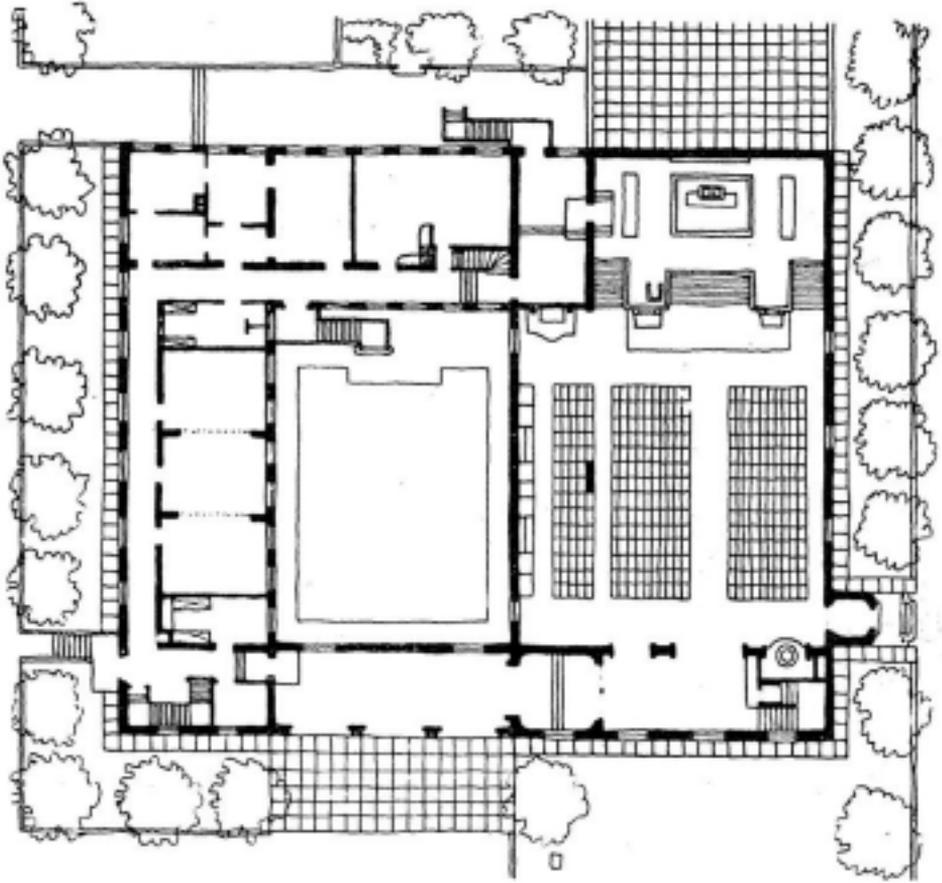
Wien, Vogelweidplatz, Kanzlerkirche, Grundriss, von Clemens Holzmeister, 1932/34
